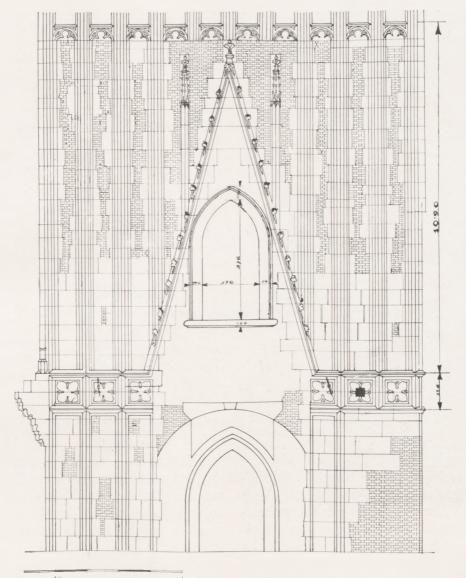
Wieża ratuszowa. Elewacja fragmentu ściany wschodniej; część piętra 1 i piętro II.
